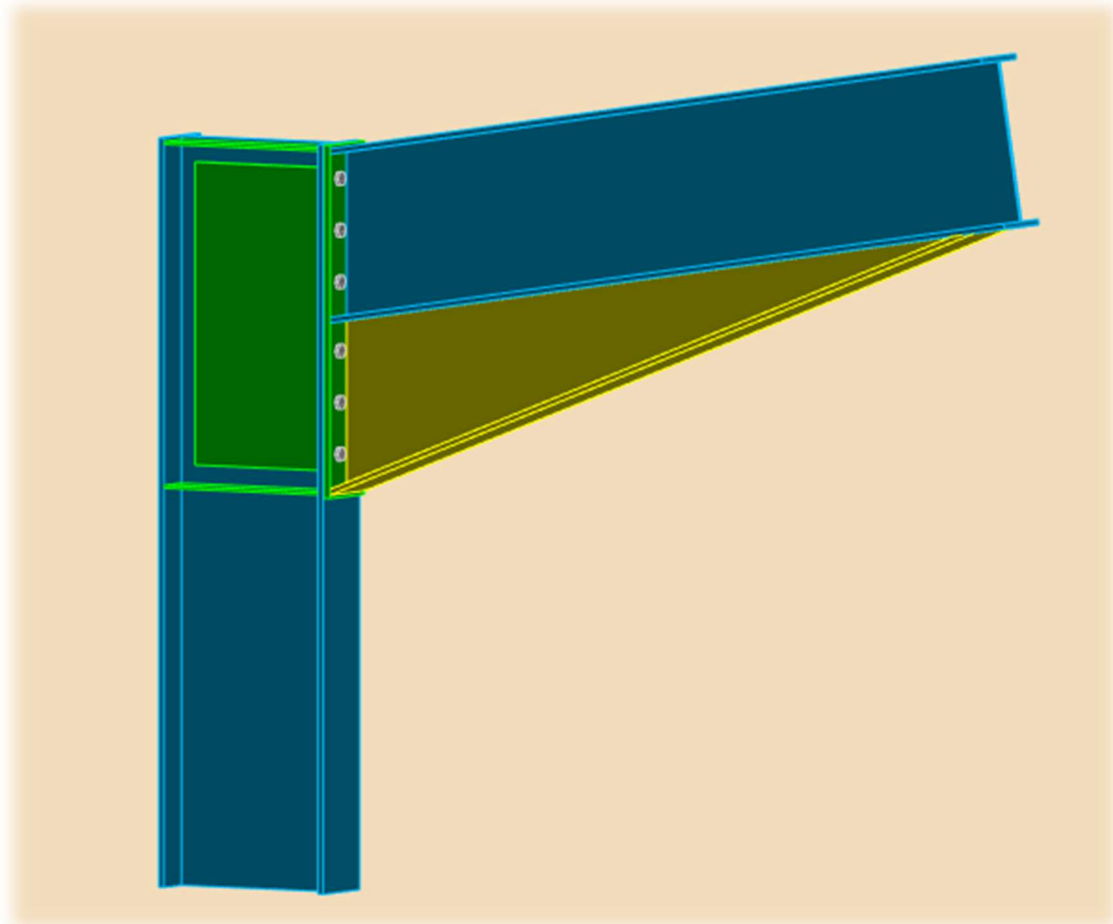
3D d'assemblage poteau - traverse (IPE500-IPE500)
